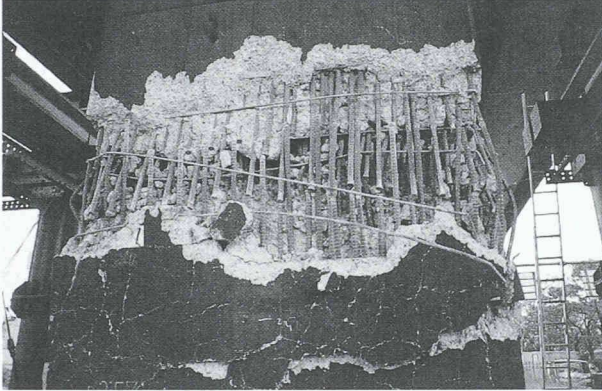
Détail de la figure 9 avec rupture des zones de liaisons par soudure bout à bout des armatures verticales
